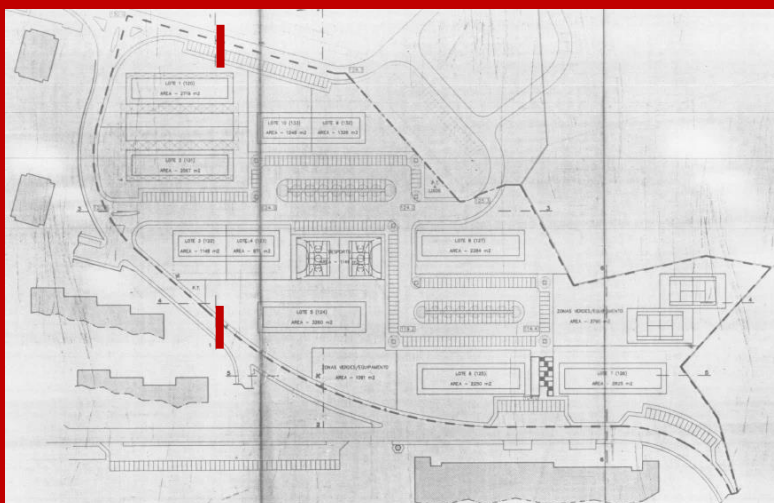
Extrato da planta do Loteamento com o Alvará nº 06/99. Indicação do corte a vermelho.
